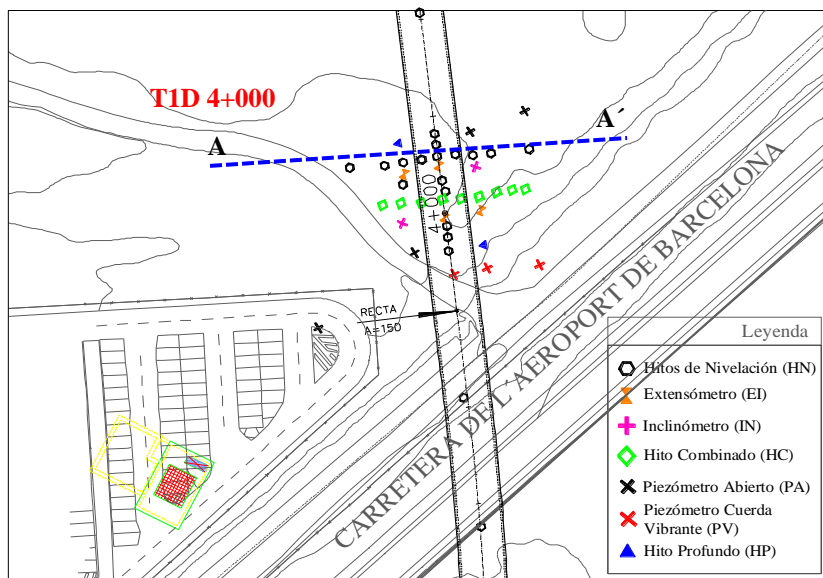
8. Situación en planta del túnel y la sección de control T1D PK 4+000
